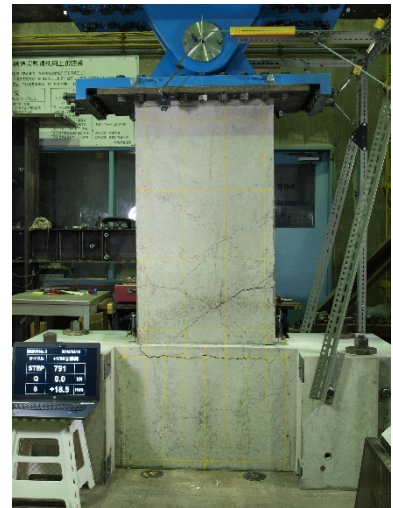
ひび割れ図 (つづき)
